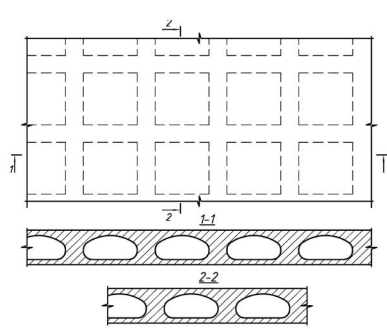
Конструкція перекриття з окремими квадратними в плані вставками
